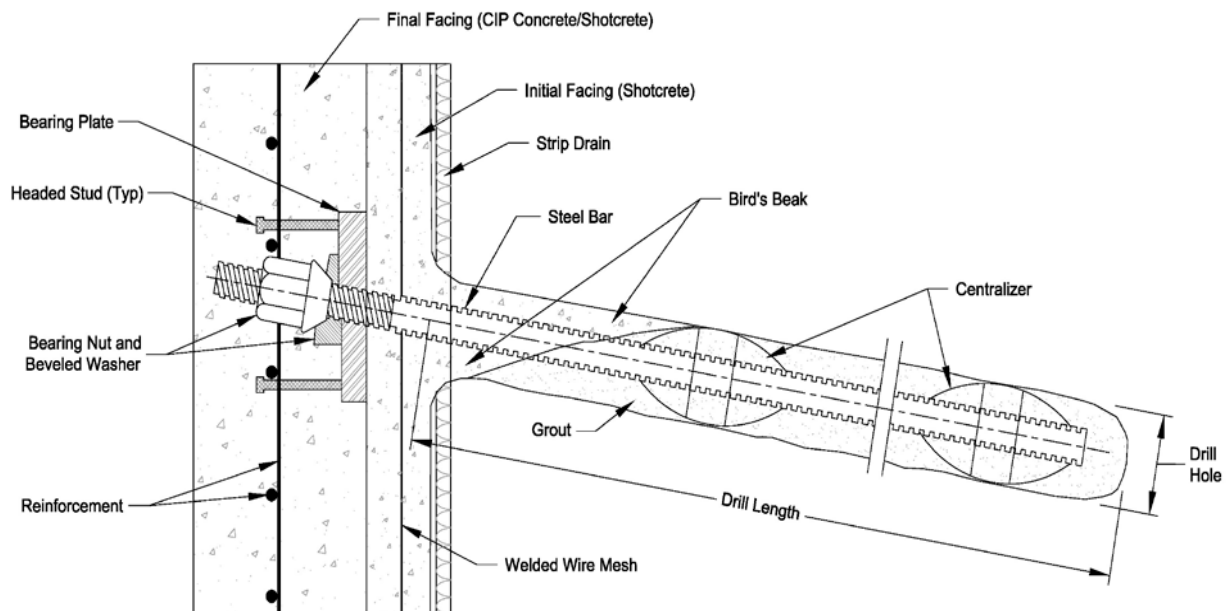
Ejemplo de detalle de los elementos de un muro de soil nailing (Fuente: Soil Nail Walls – Reference Manual (FHWA, 2015))
